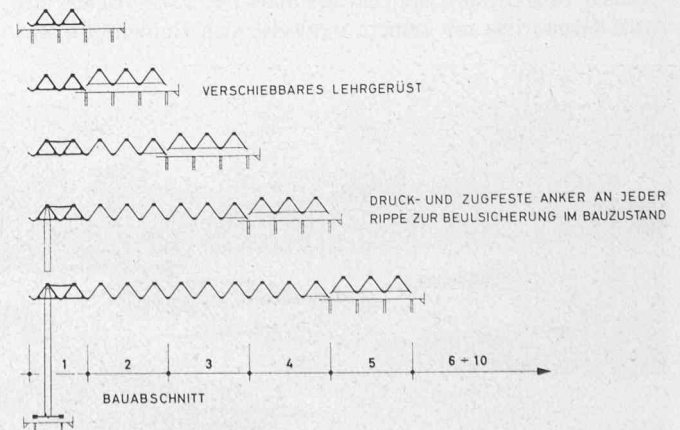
Paketumschlaghalle München, Schema der Bauausführung in 10 Bauabschnitten
